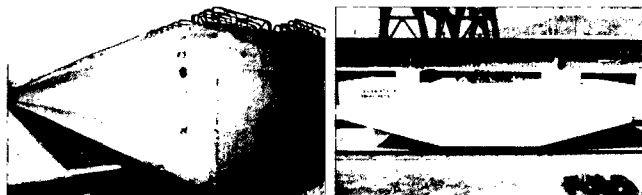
Vigas longitudinales y vigas cabezales prefabricados en la Planta Bayóvar.
